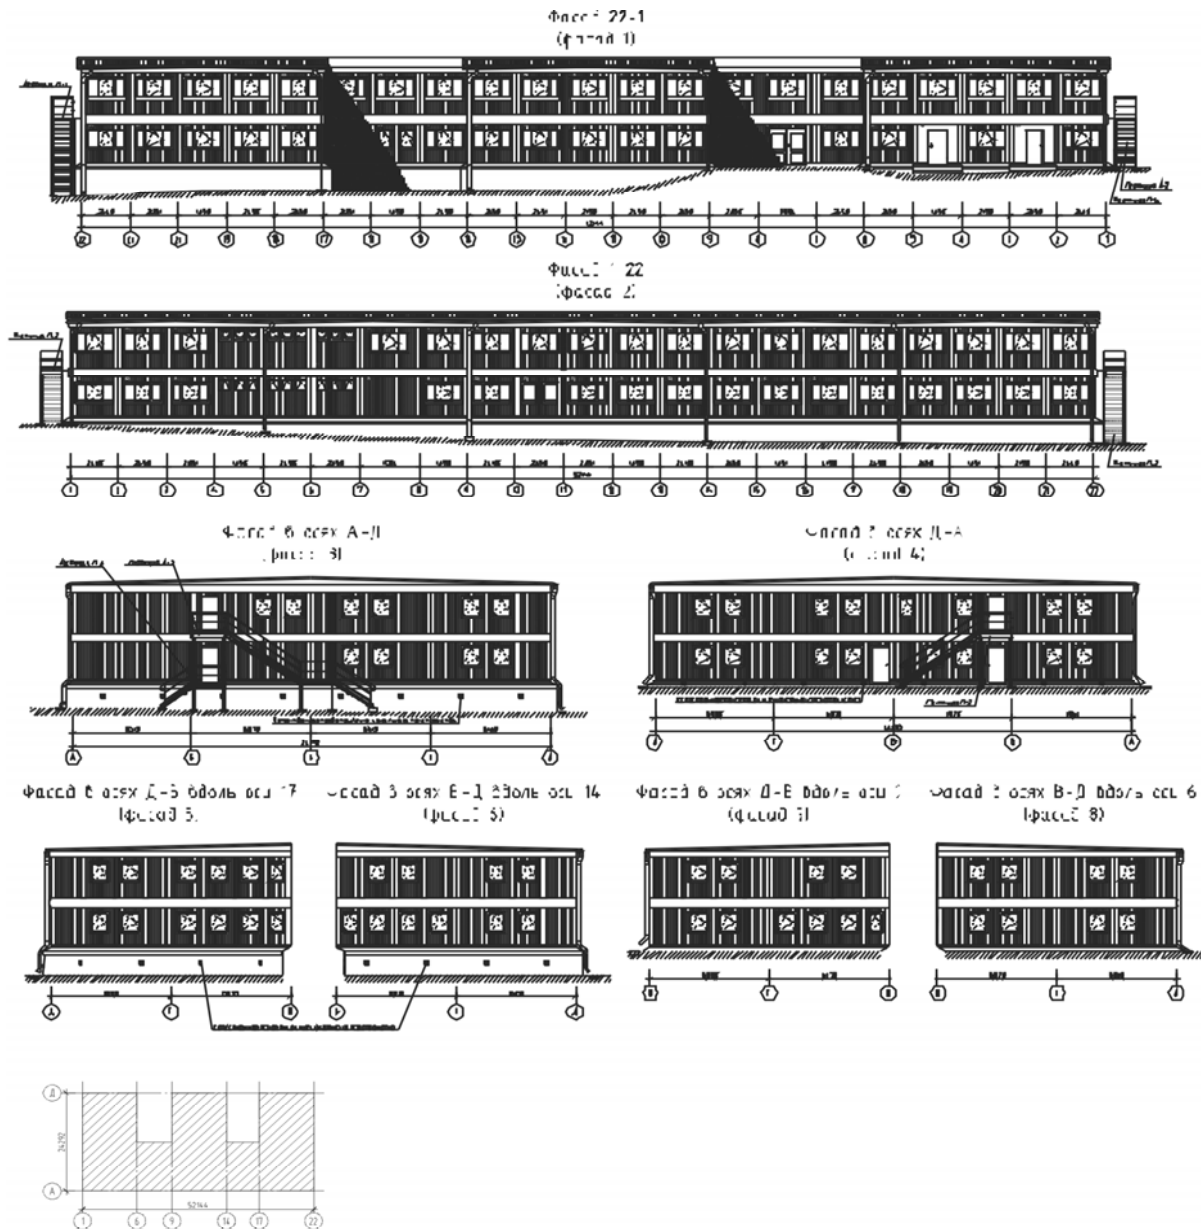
Модульное здание. Фасады. Схема расположения фасадов.
